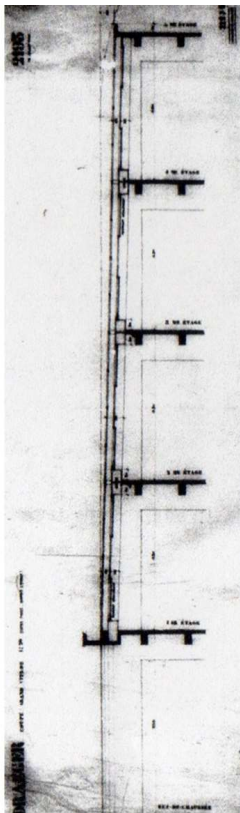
Sección vertical por muro neutralizante. Ciudad del Refugio. París 1930.
